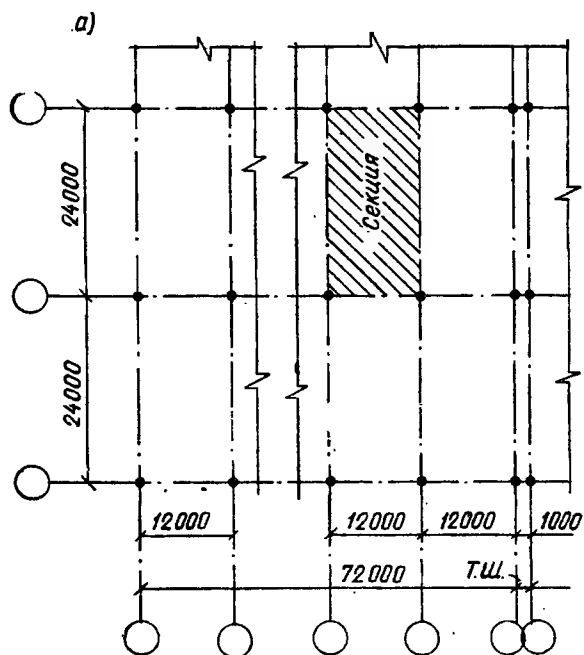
Схематические планы зданий с конструкциями типа «Берлин»
